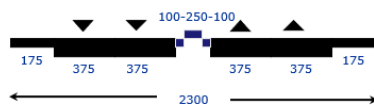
SEZIONE STRADALE TIPO B
